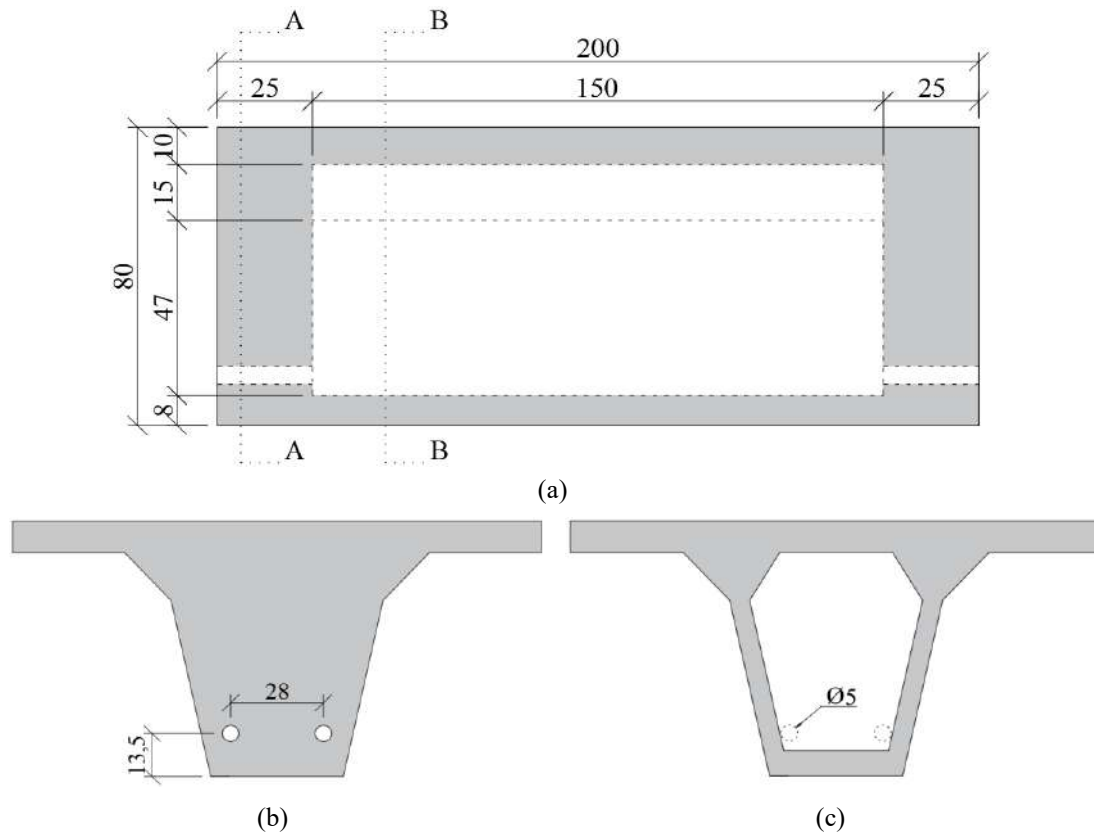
Concepção estrutural da estrutura a ser concretada (Fase 2): (a) Vista lateral, (b) Corte A-A, trecho maciço, e (c) Corte B-B, trecho celular; dimensões em cm.
